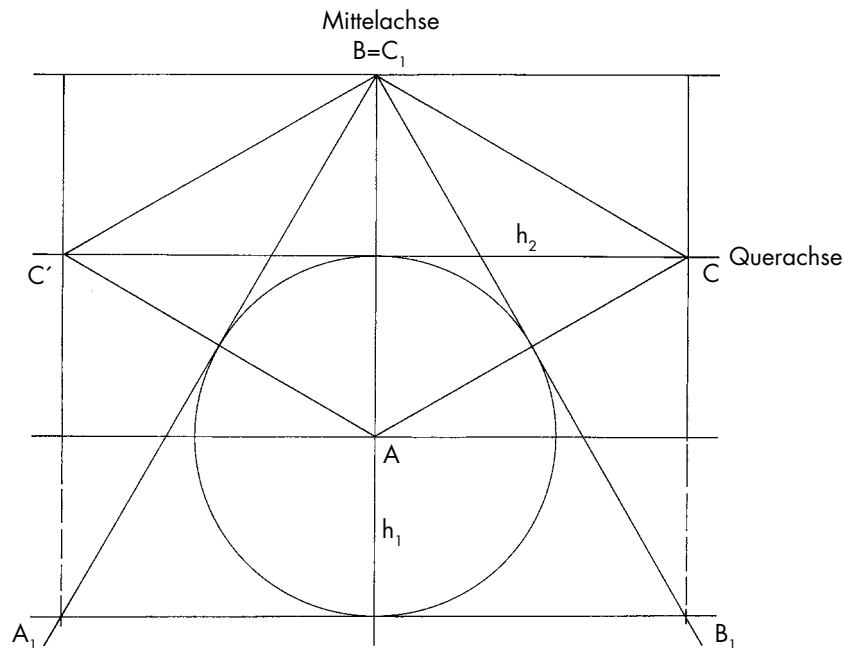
b Oberüttfeld, Grundrißentwurf. Variante II, Stufe II. M. 1:250.
